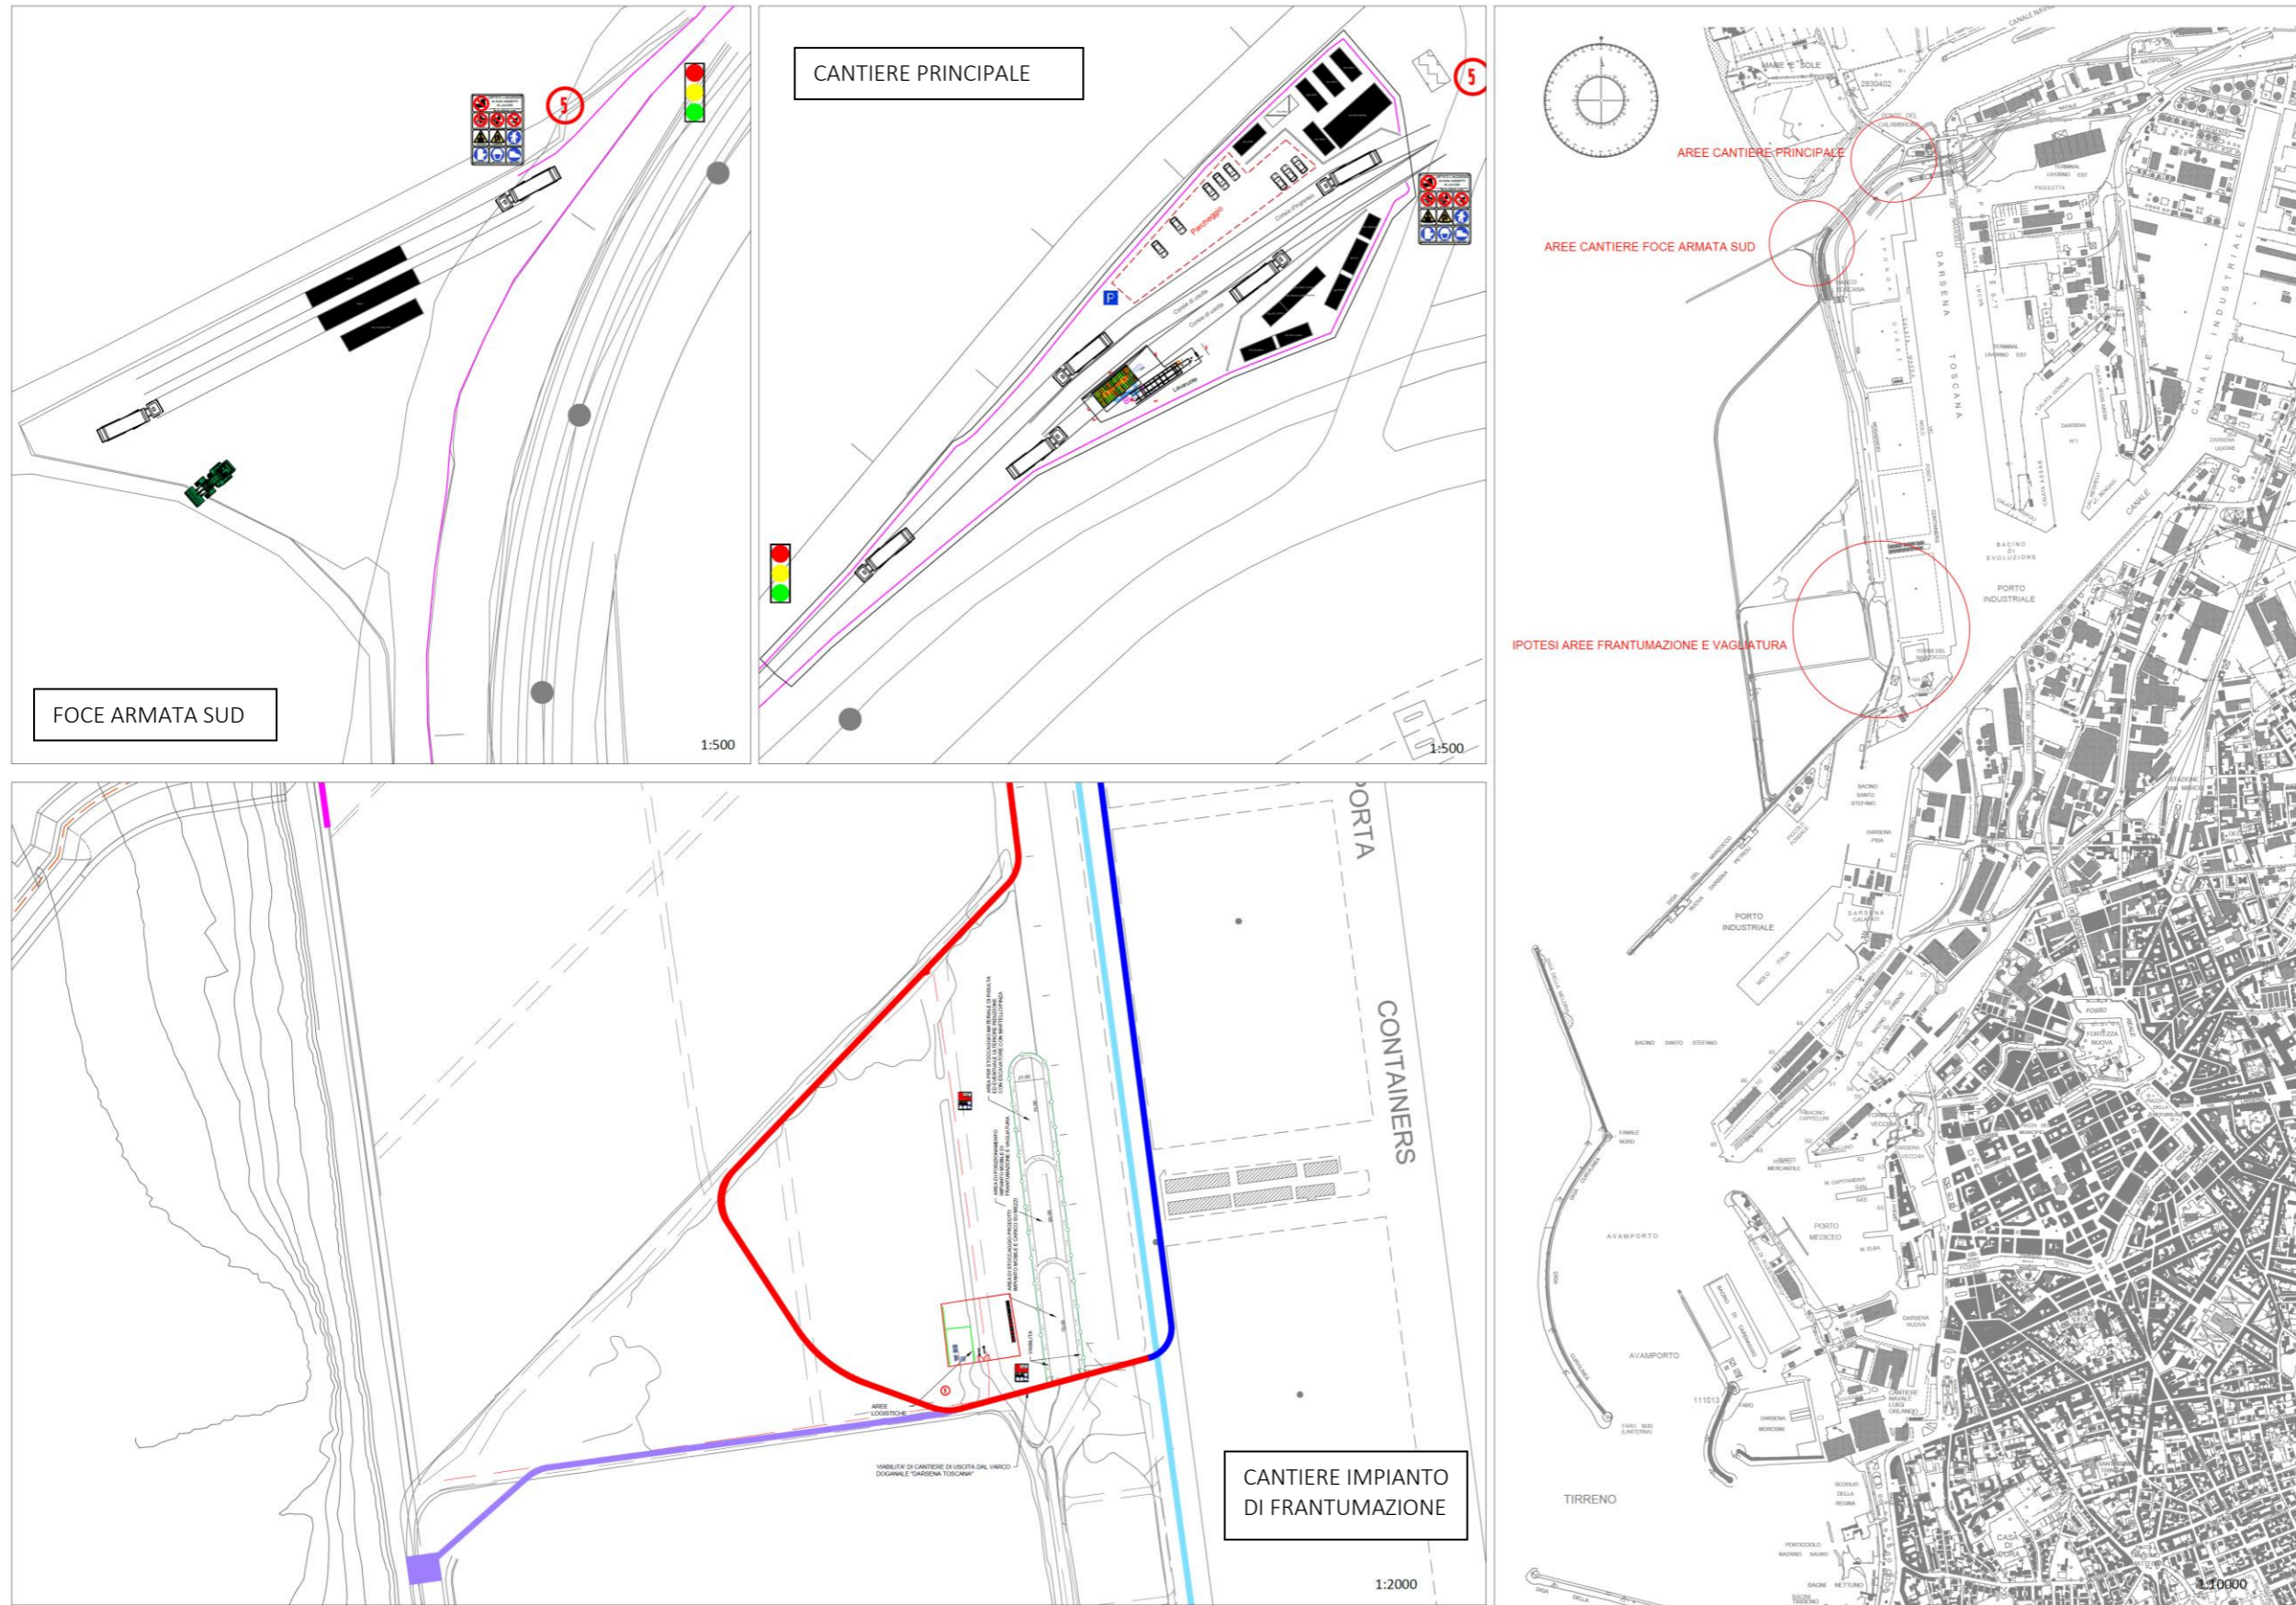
cantieri all'interno dell'area portuale (cantiere principale, foce armata sud e cantiere impianto di frantumazione)
